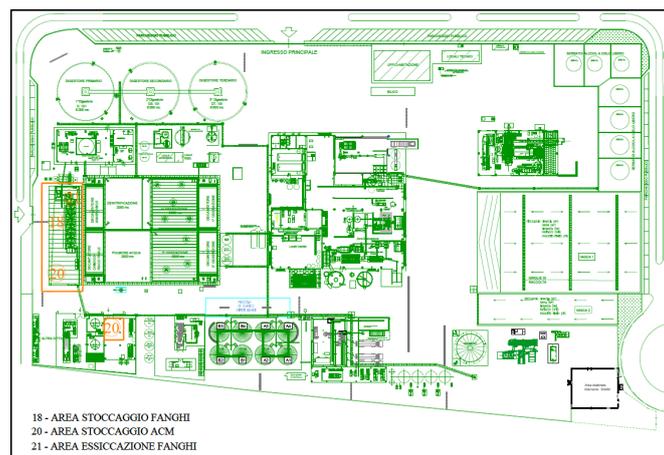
planimetria della sezione ESSICCAZIONE FANGHI e PRODUZIONE DI ACM
